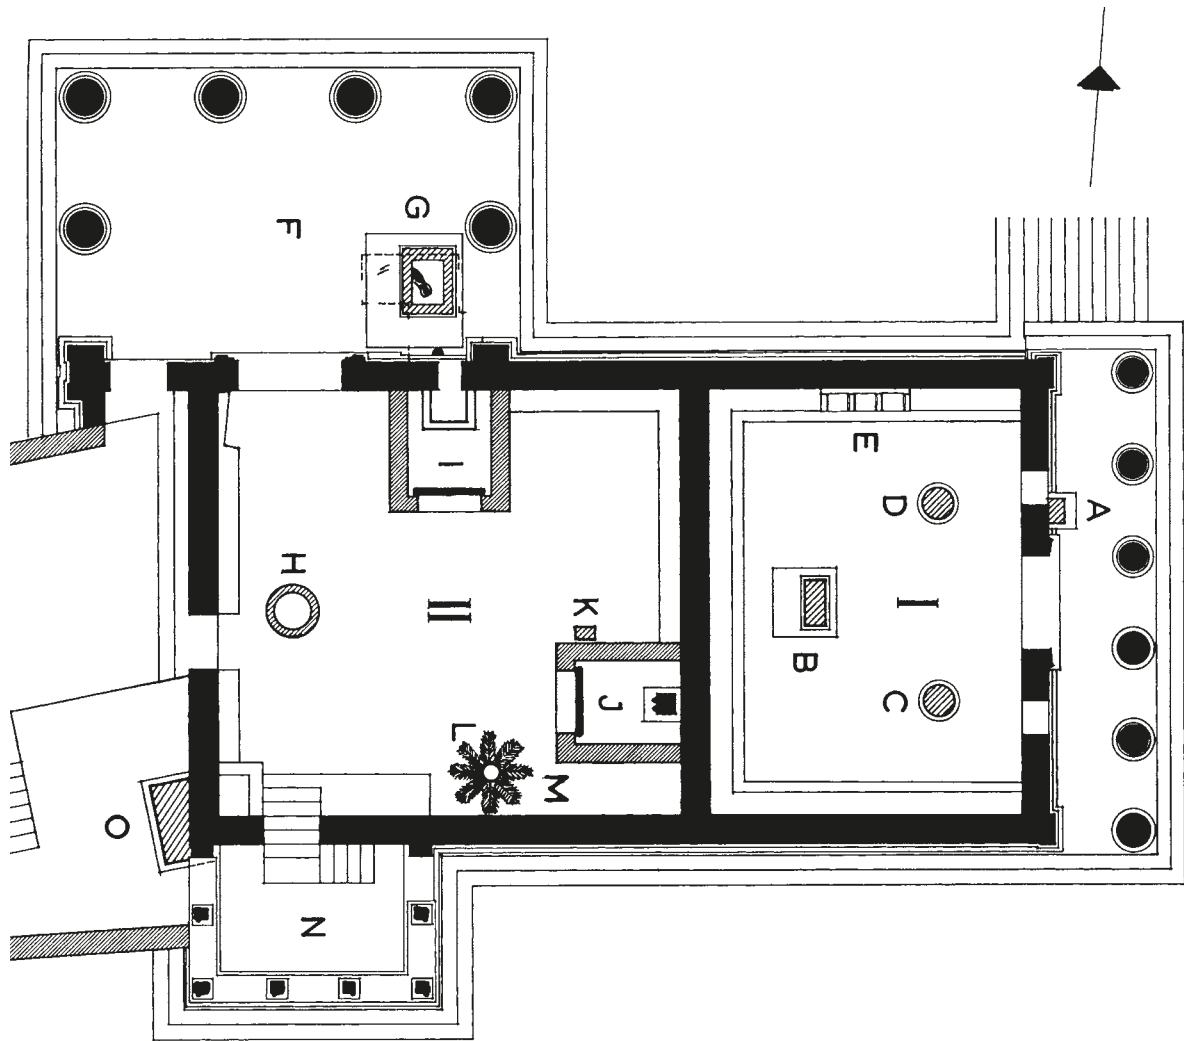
Erechtheion, Grundriss nach Travlos (1971). J: Adyton für das ἀρχαῖον ἄγαλμα
